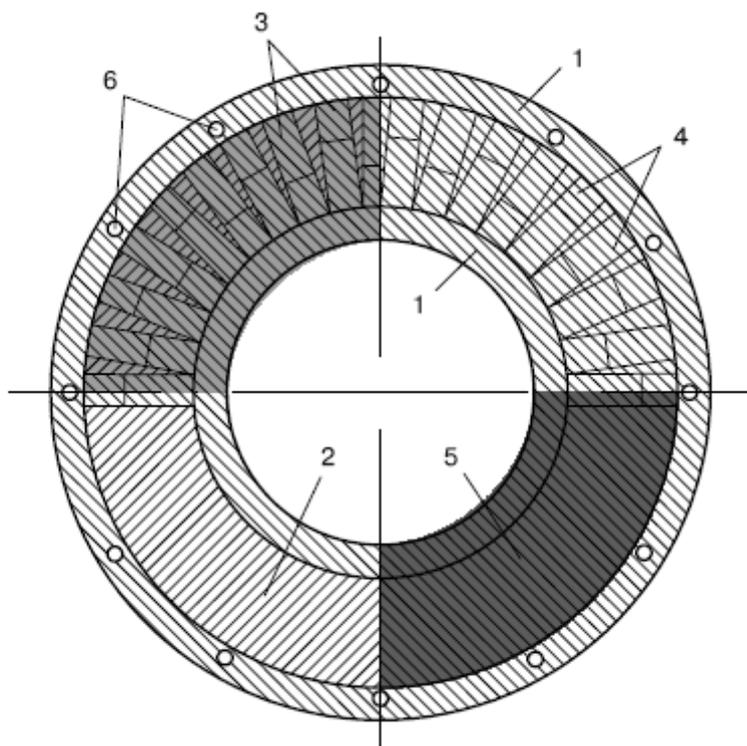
Схема кладки в 1,5 кирпича кирпичного колодца круглого сечения: 1 – бетонная подушка; 2 – цементный раствор под кладку; 3 – первый ряд кладки; 4 – второй ряд кладки; 5 – третий ряд кладки; 6 – арматурный каркас
